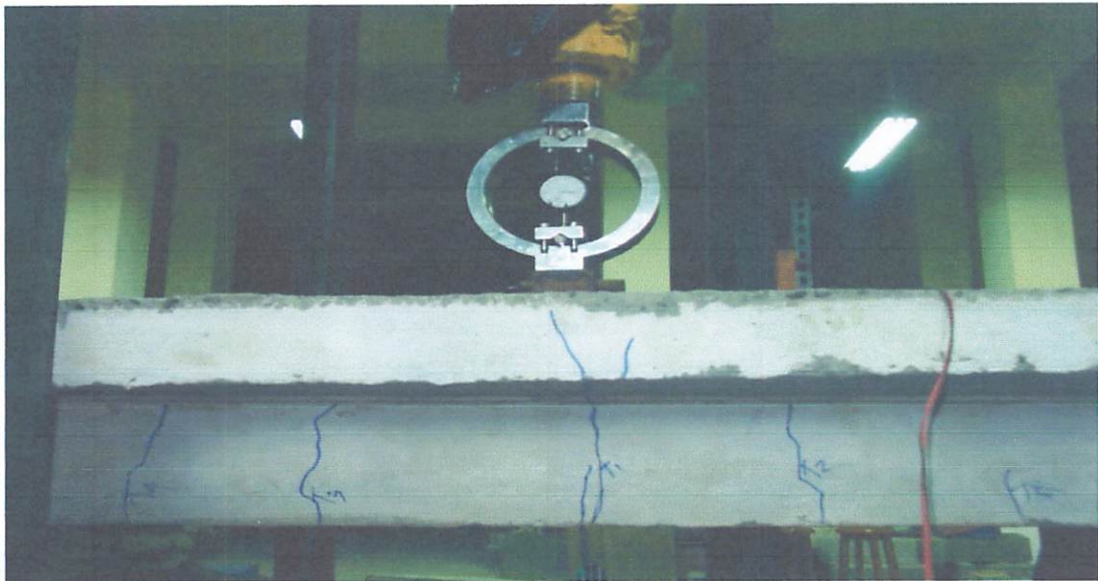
Retak yang terjadi pada balok T tanpa sambungan beton dan tulangan B (BTS-B)
